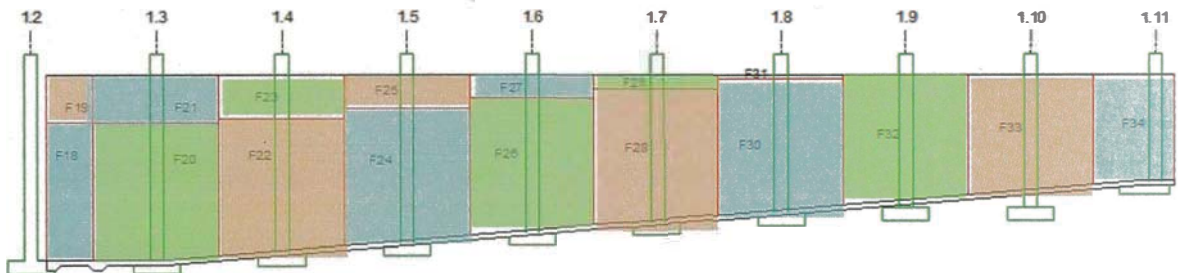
Sectorización Muros Faja 5 - Eje A (Fuente propia)
